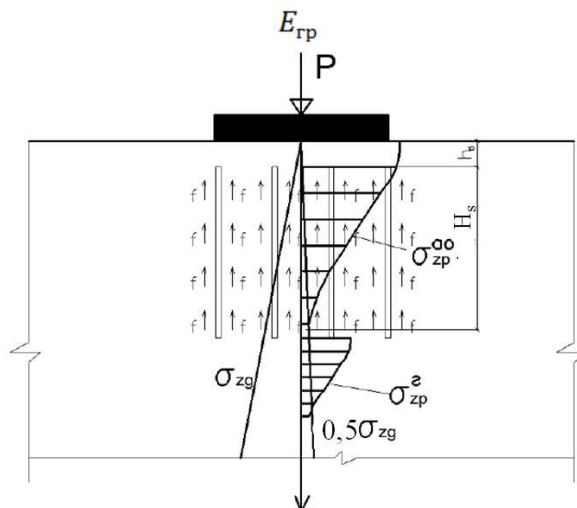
Схема для расчета осадки армированного вертикальными элементами грунтового основания
